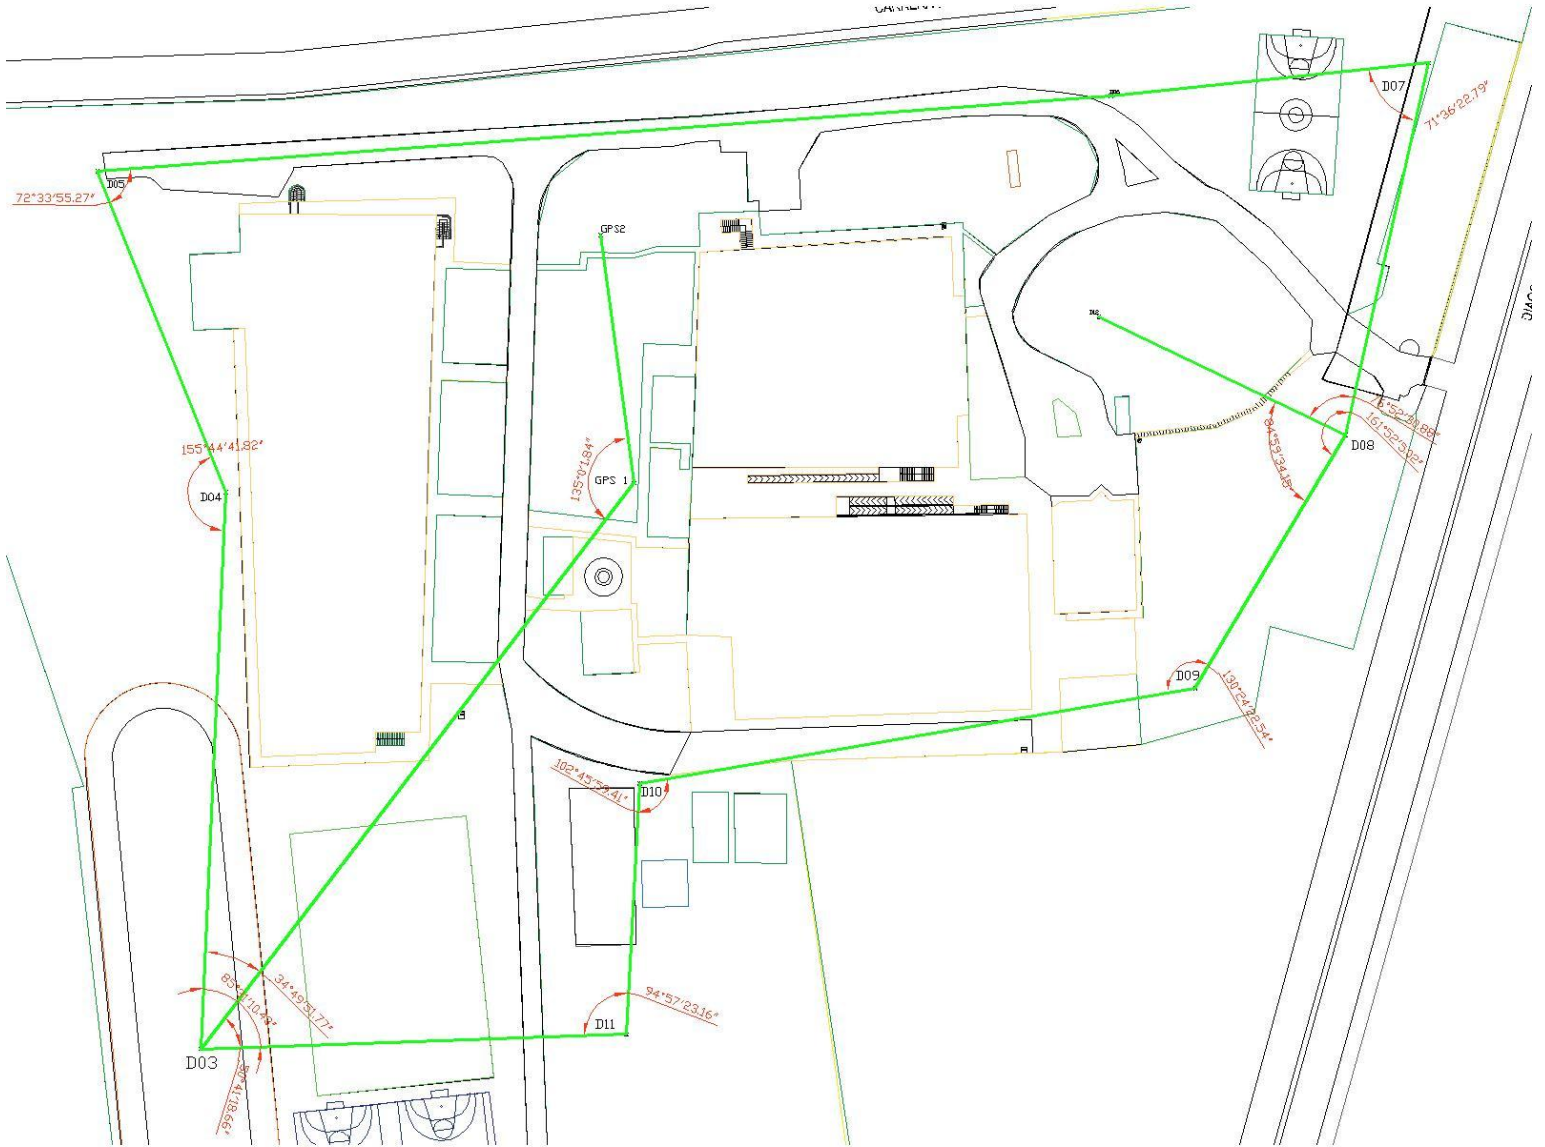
Plano de la poligonal cerrada utilizada en el Levantamiento planimétrico y altimétrico
